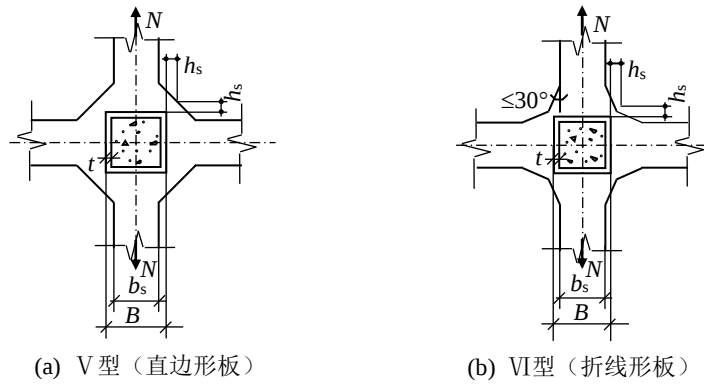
矩形不锈钢管混凝土加强环板的类型示意图
